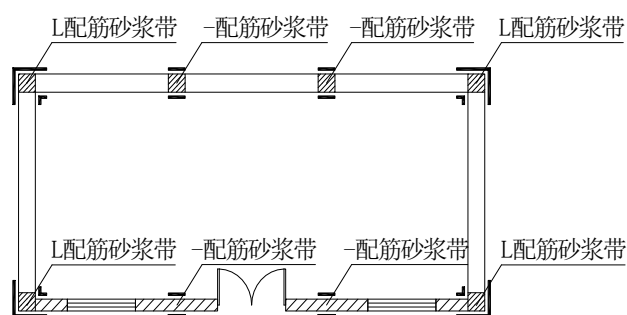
三间房竖向配筋砂浆带的布置示意图
